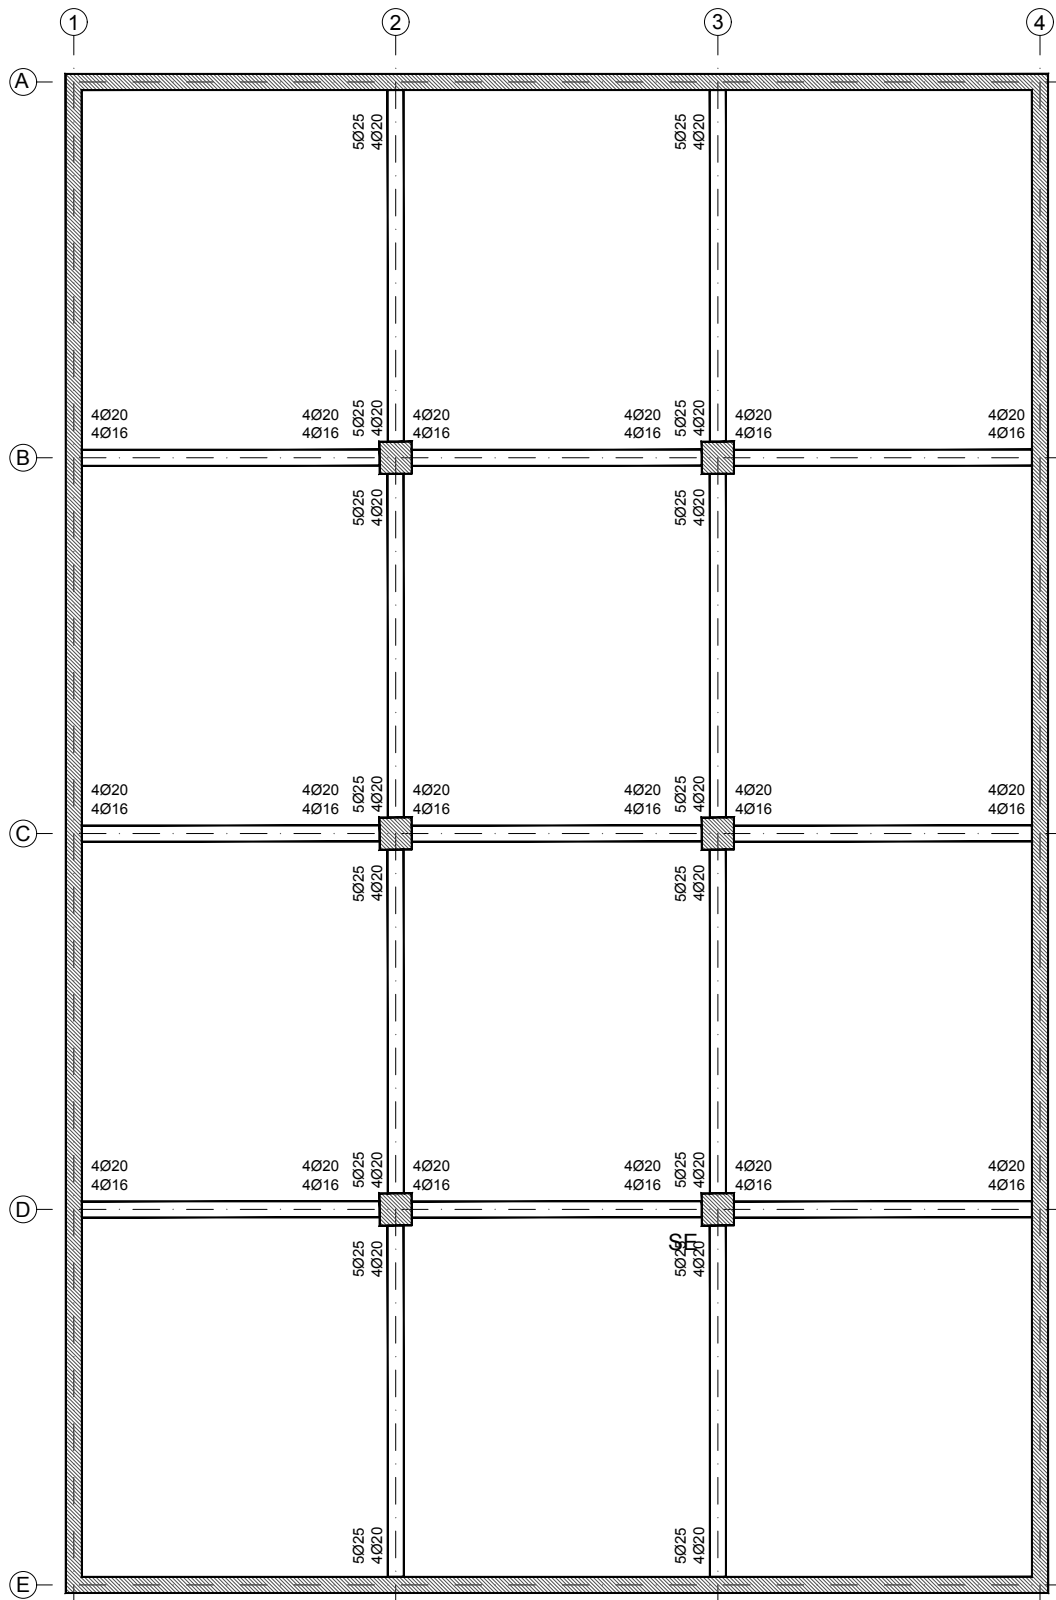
Armadura longitudinal das vigas – Piso 0.
